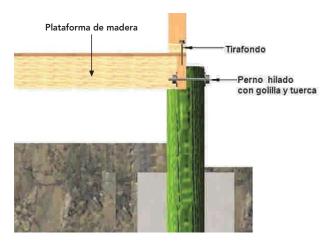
42: Anclaje de tabique perimetral soportante con tirafondos a viga principal de la plataforma de madera montada sobre pilotes.
